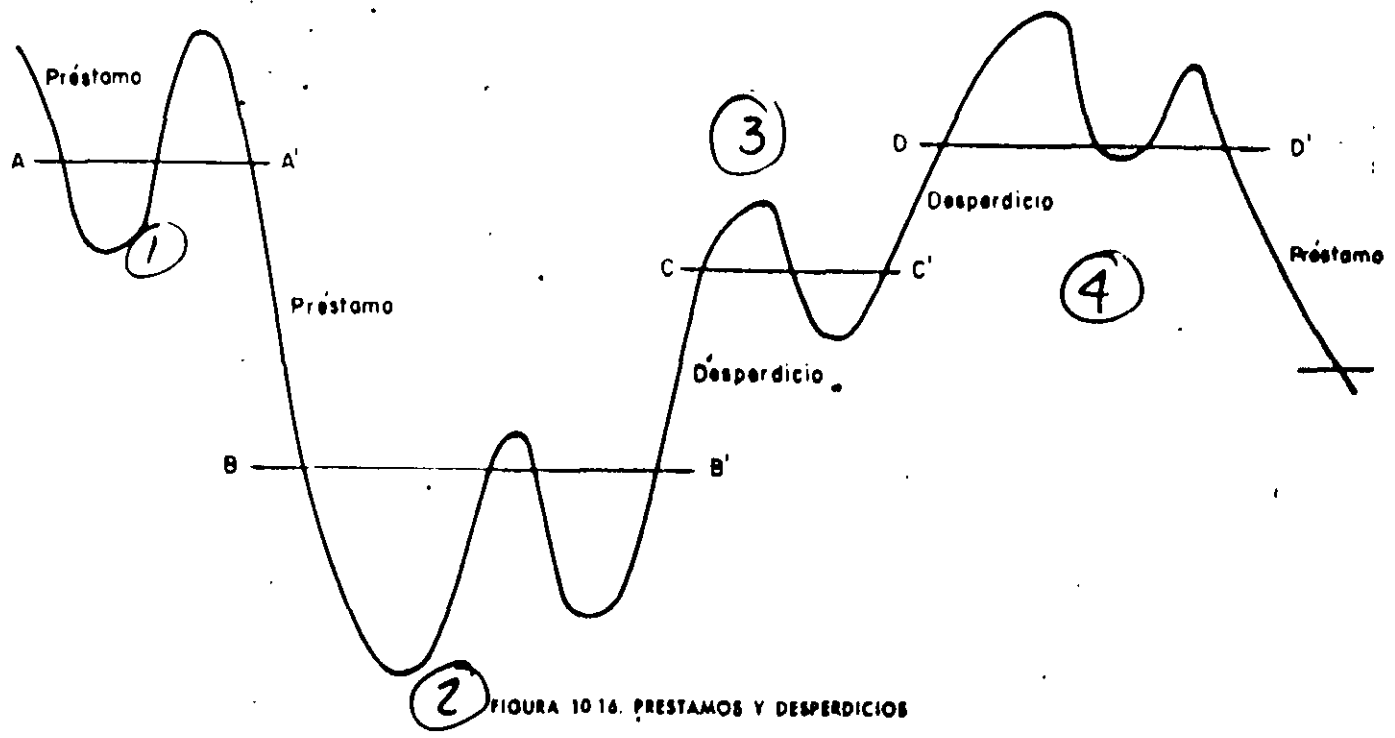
16. PRESTAMOS Y DESPERDICIOS
